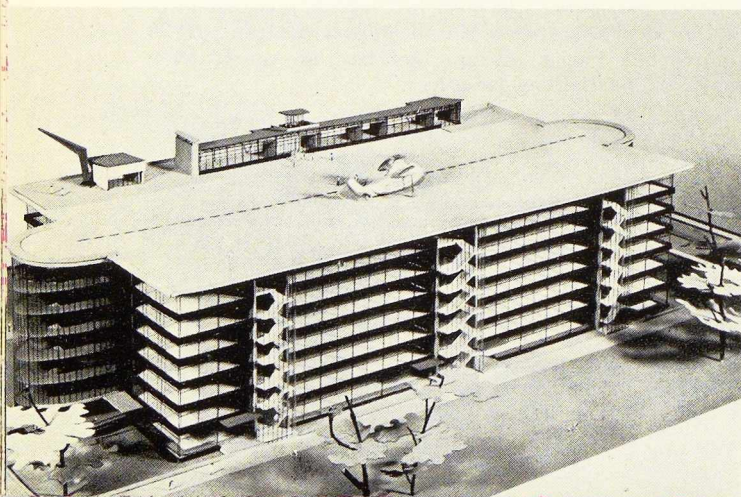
Maquette d'un bâtiment à étages pourvu d'une toiture-héliport.
